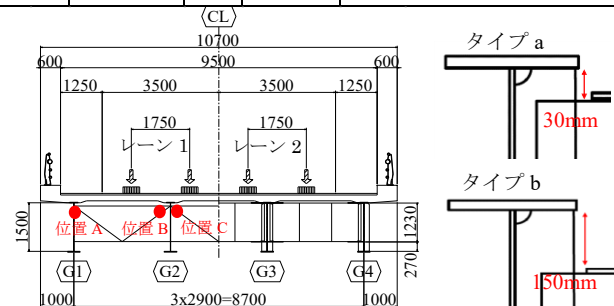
幅員構成と走行レーン位置図、および横桁取付け位置
